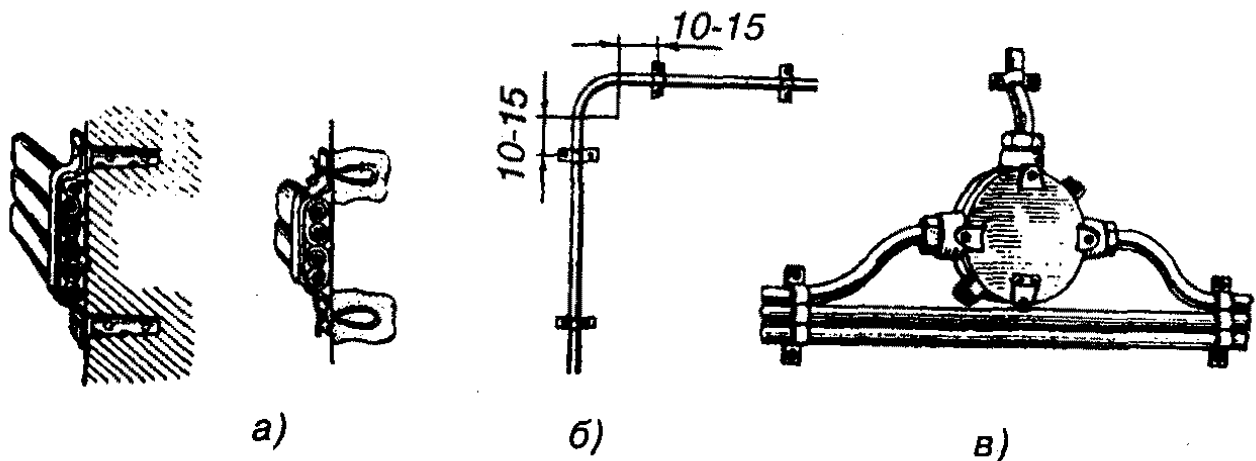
Монтаж электропроводок легкими кабелями с резиновой и пластмассовой изоляцией:
